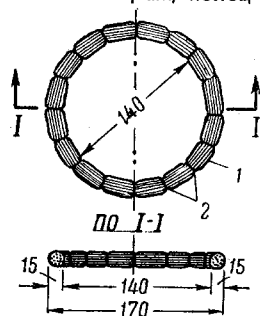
Фашинное кольцо с круглым сечением стенок:
